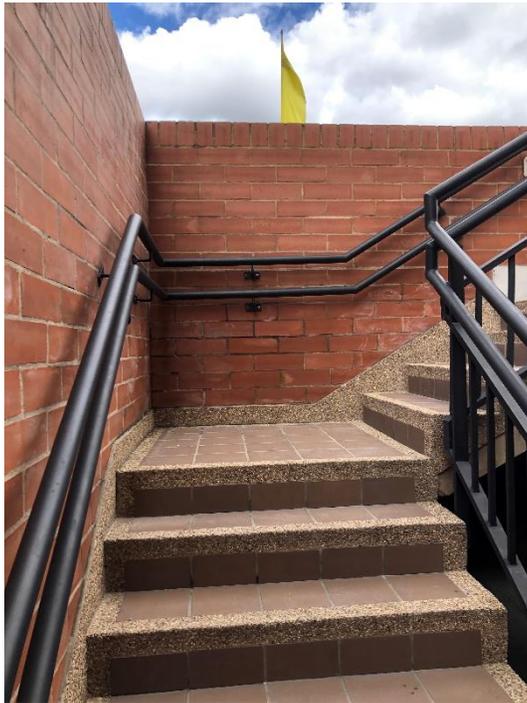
Muros Escalera con humedad salida hacia el parqueadero V-22
